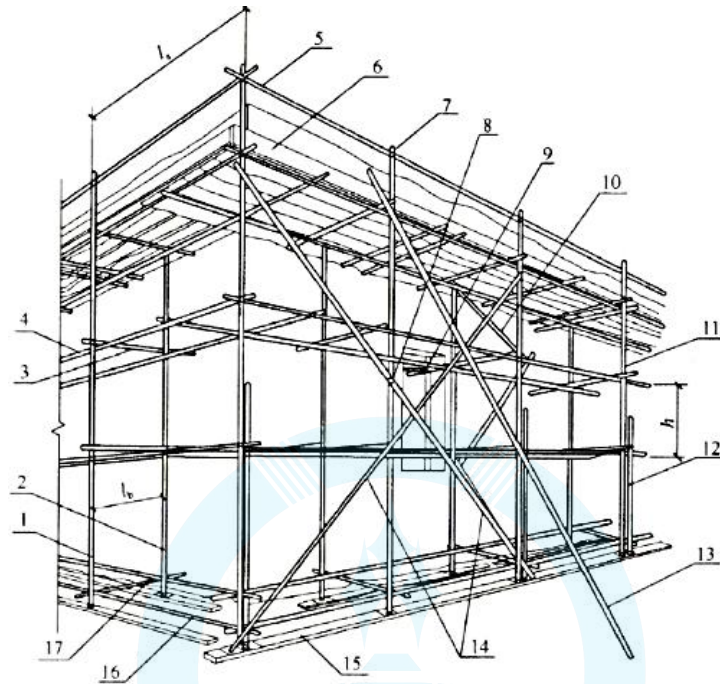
双排扣件式钢管脚手架各杆件位置示意
